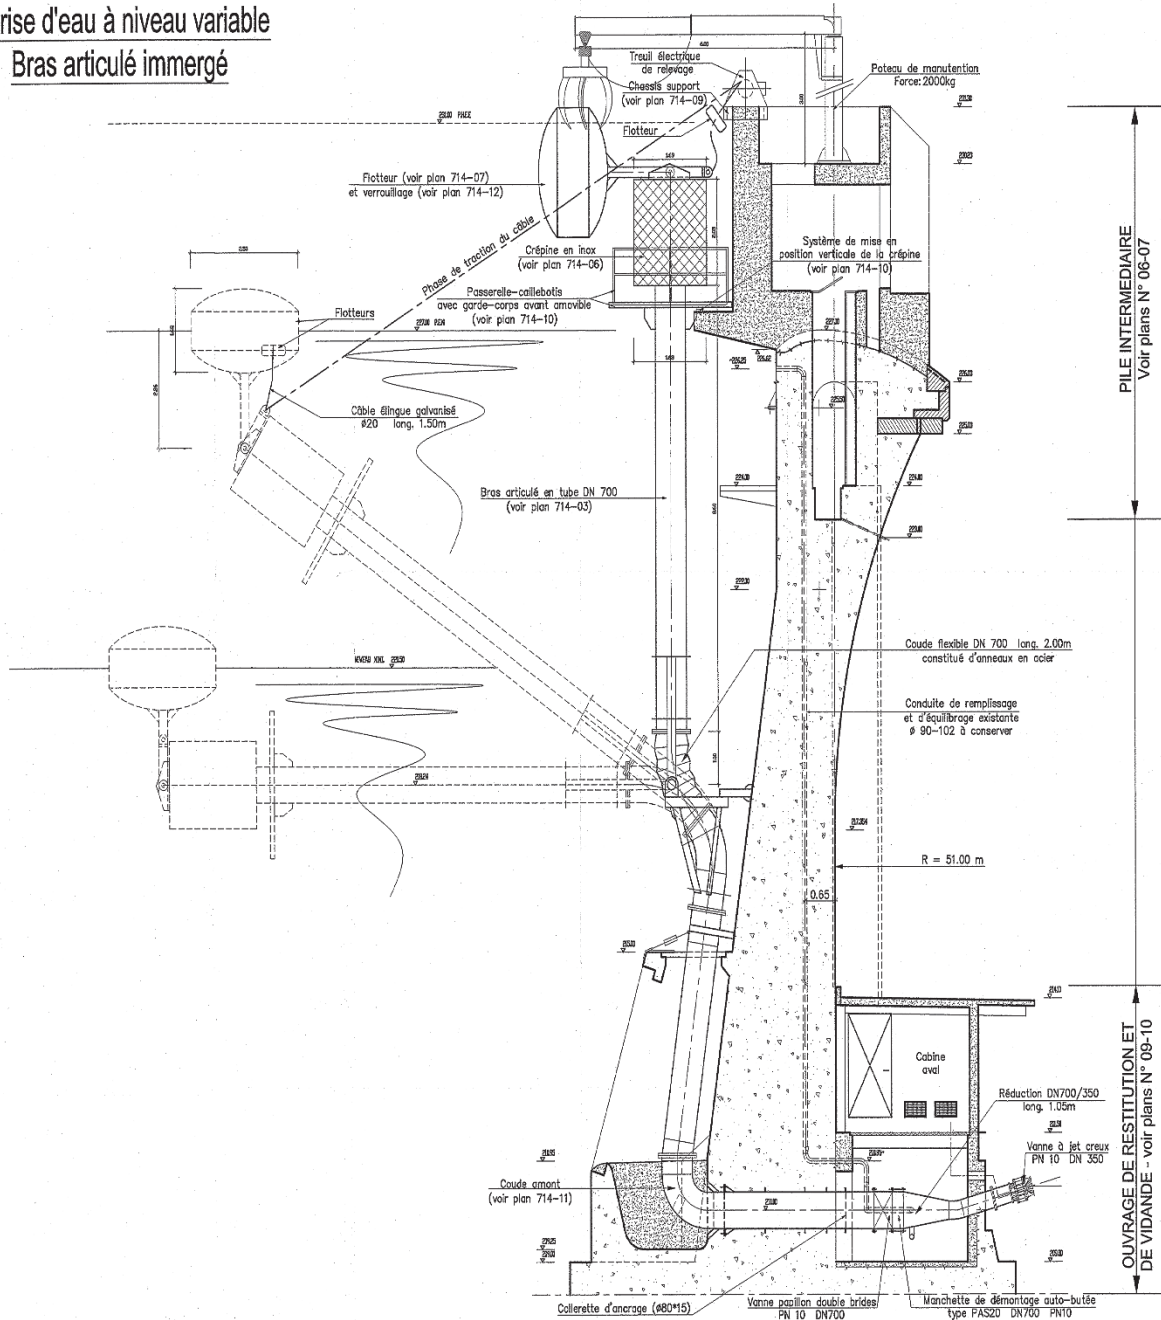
Coupe de l'ouvrage au droit du dispositif de restitution
